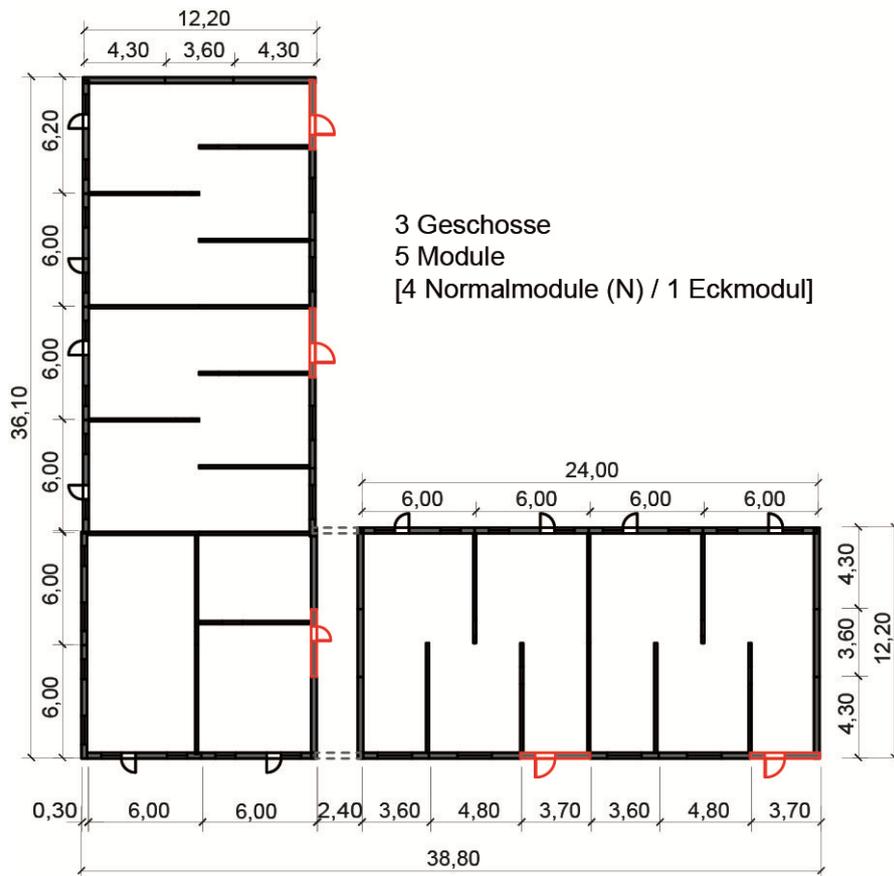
Grundriss Erdgeschoss, tragende Wände (M 1:400)
